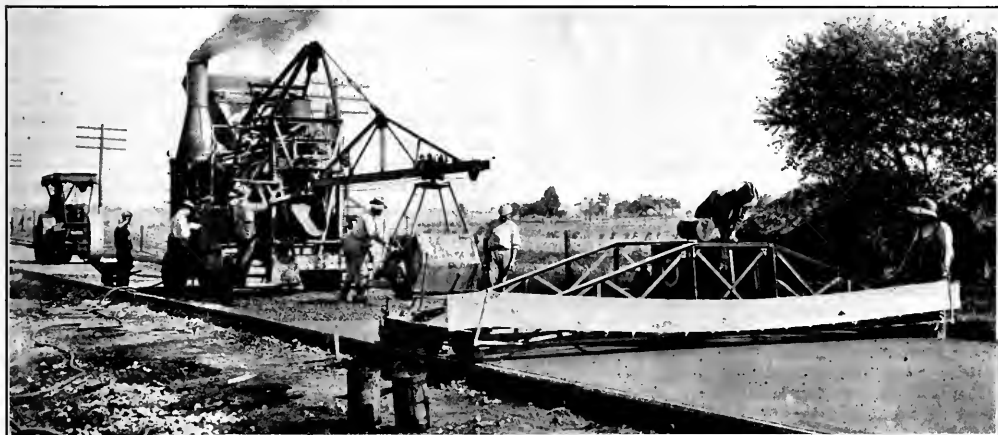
MEZCLADORA Y MÁQUINA PARA EL ACABADO DEL PAVIMENTO
